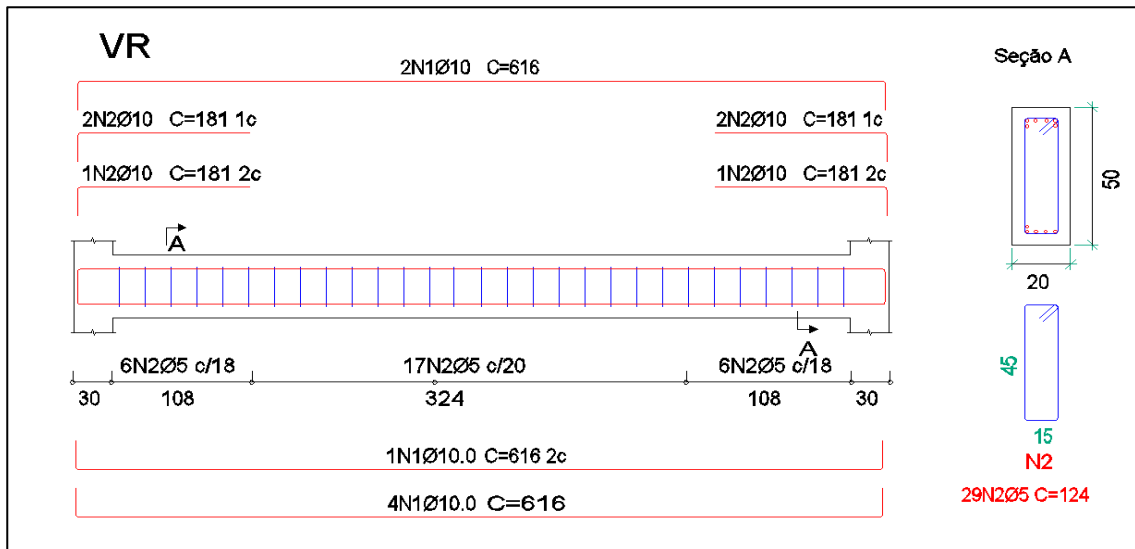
Detalhamento da viga de referência. Dimensões em centímetros
